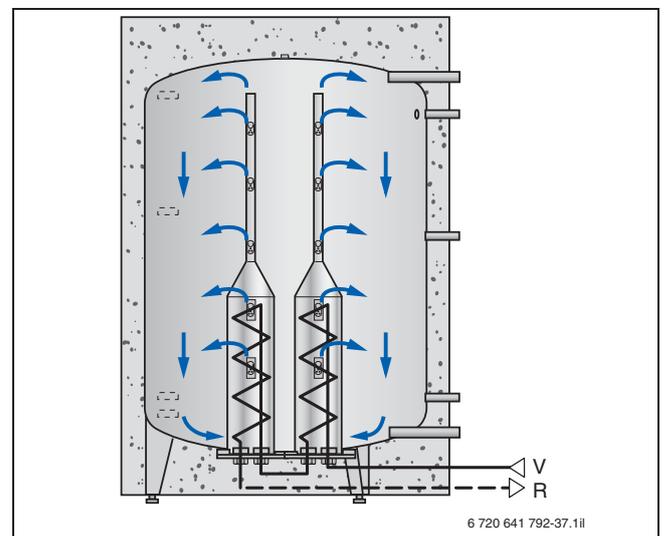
Struttura Logalux PL1500; dimensioni, attacchi e dati tecnici → pagina 38 e seguente
